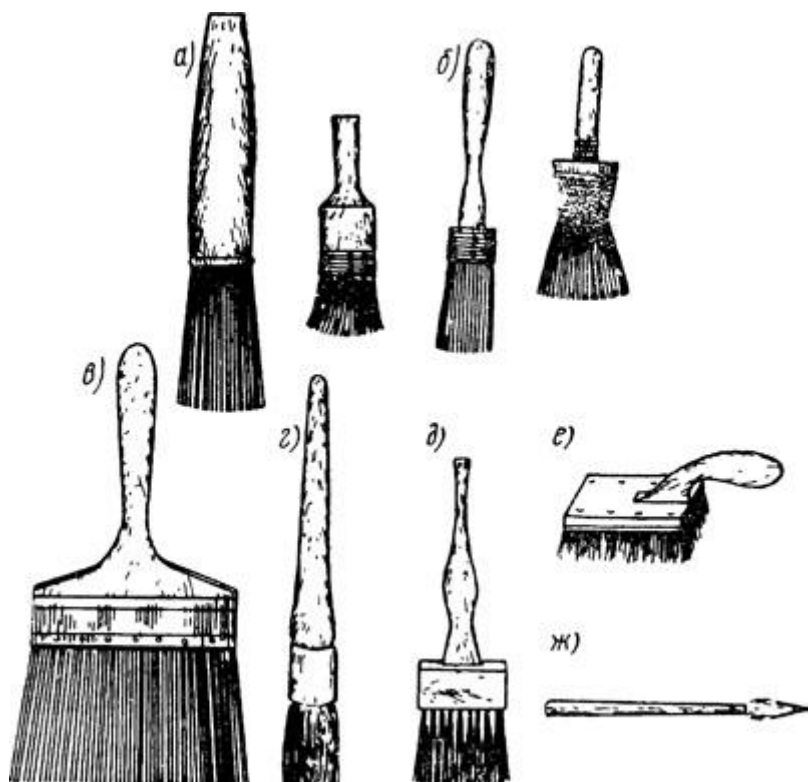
Кисти волосяные: а — ручники; б — маховые; в — флейцы; г — обводные; д — разделочные; е — торцовки; ж — маркировочные
